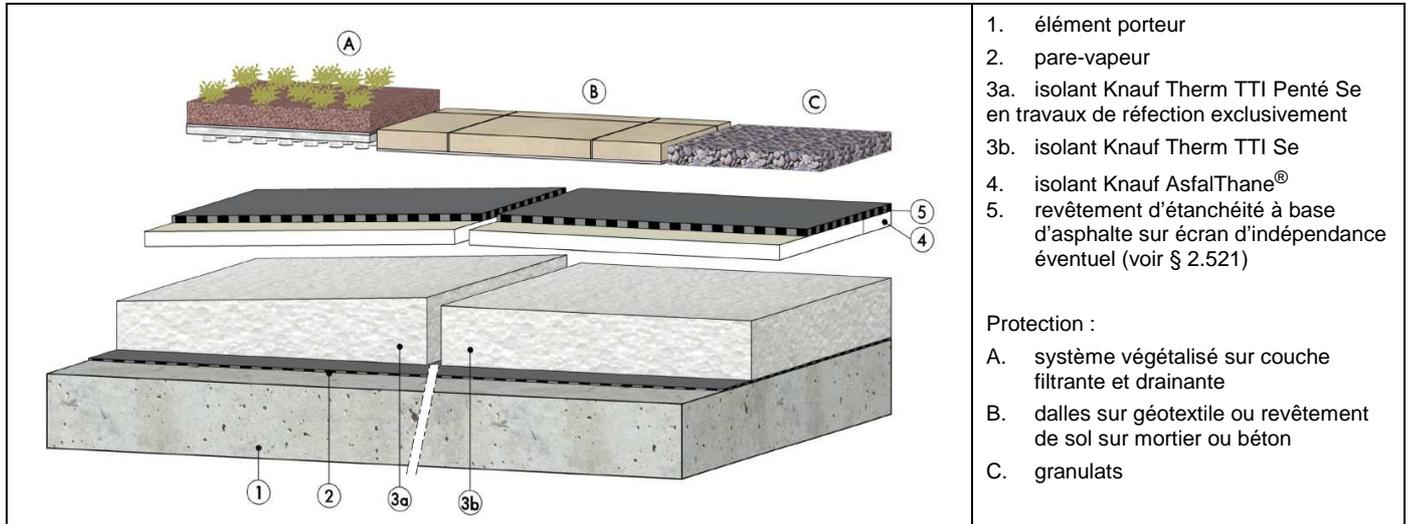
exemple de toiture-terrasse avec élément porteur en maçonnerie, Knauf Thane ET Se + Knauf AsfalThane® sous revêtement d'étanchéité en asphalte et protection lourde
